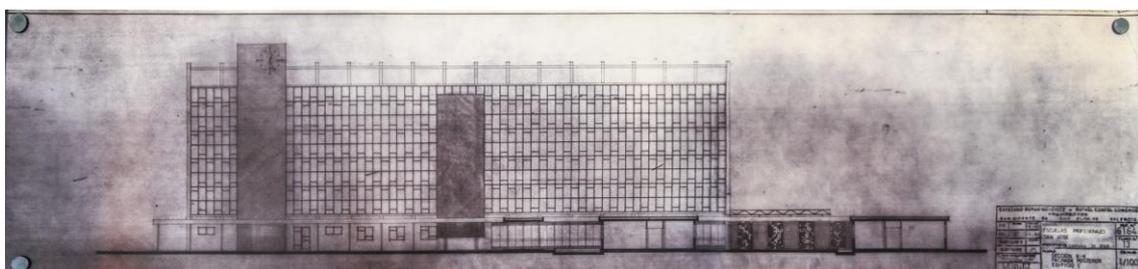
Alzado posterior edificio entrada, fachada norte. *Archivo Escuelas San José.
